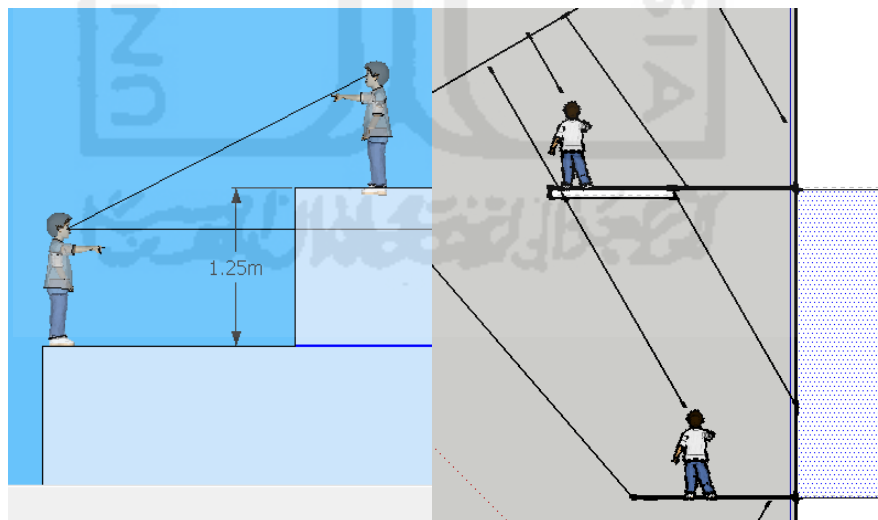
Skema keselamatan Bangunan Lantai tipikal
